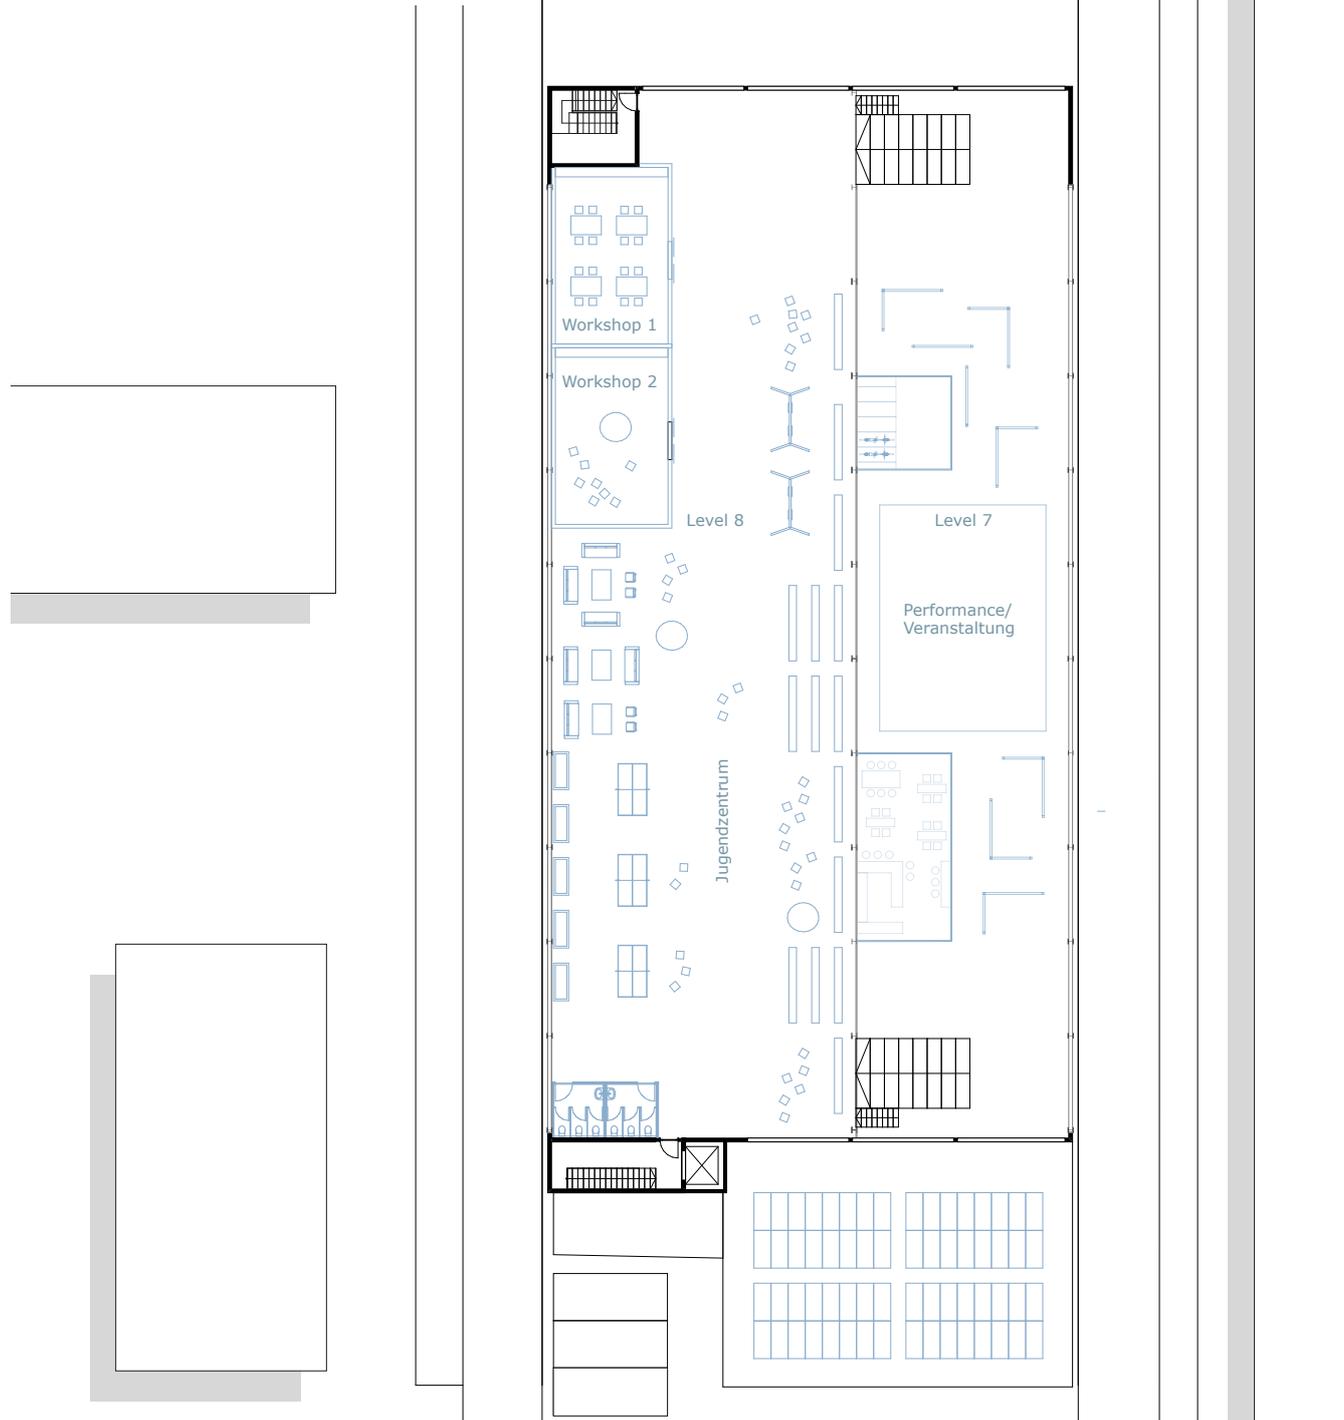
Parkhaus Migerkastraße: 7. und 8. Level - M 1:400
